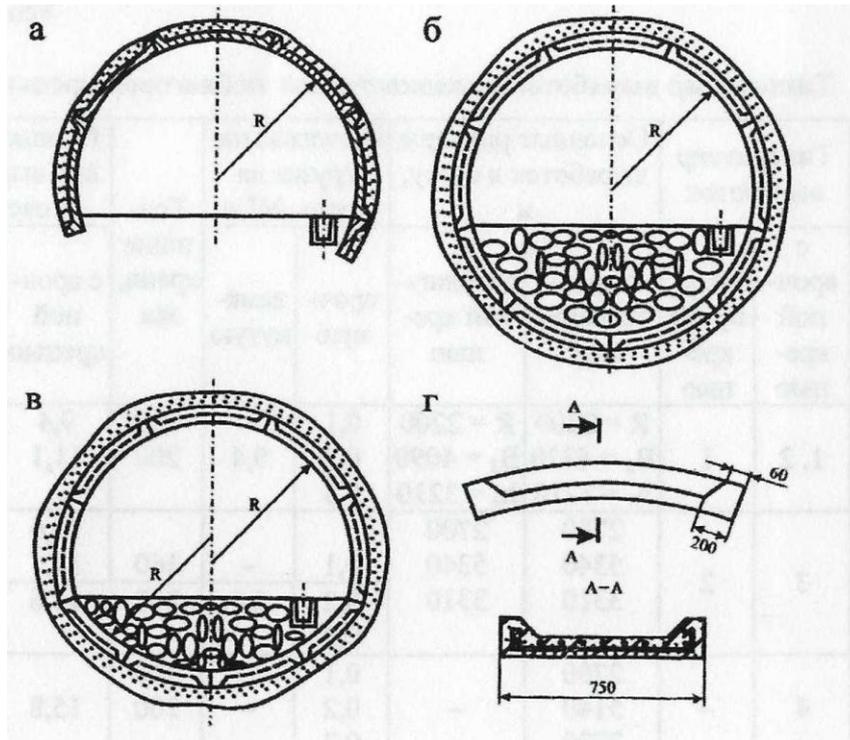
Железобетонная гладкостенная тубинговая крепь ГТК
